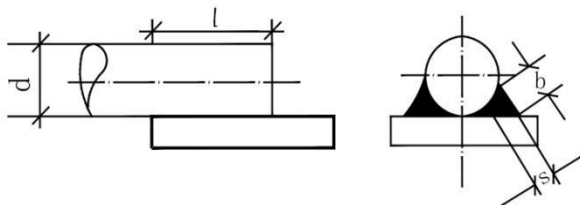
钢筋与钢板搭接焊接头
